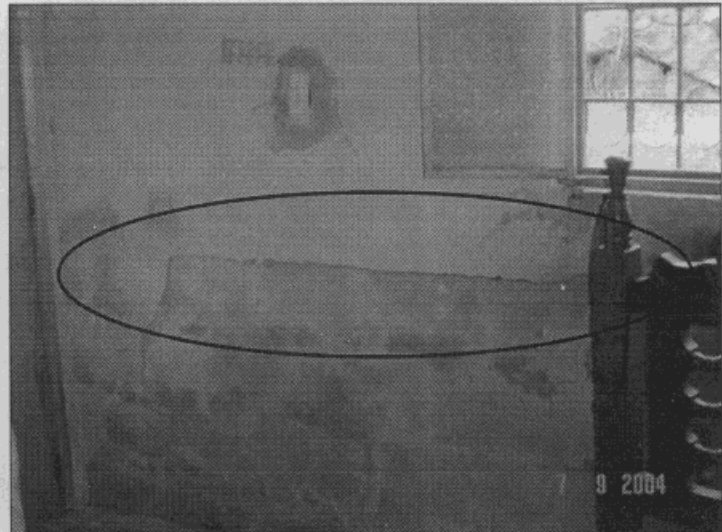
Se observa grieta en la parte superior del muro del costado norte de la vivienda.
